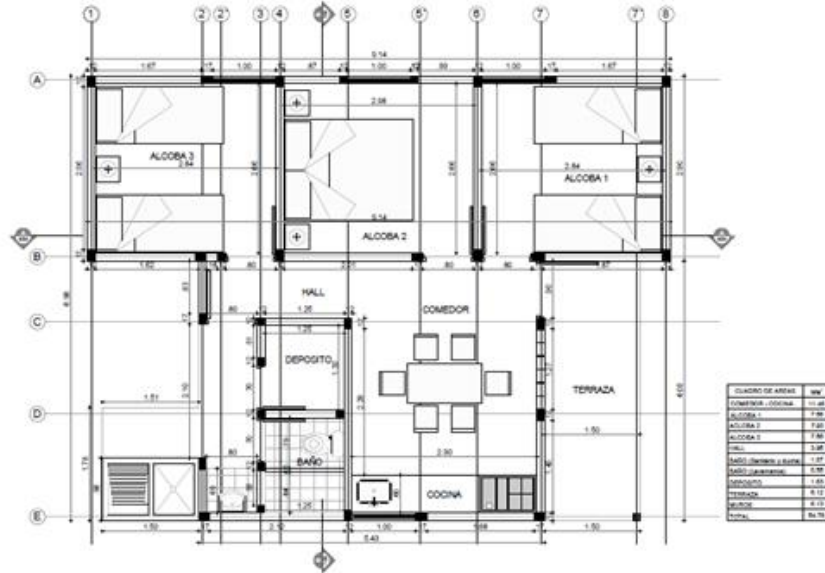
Plano de planta VISR Proyecto Tipo SV-HT-001
